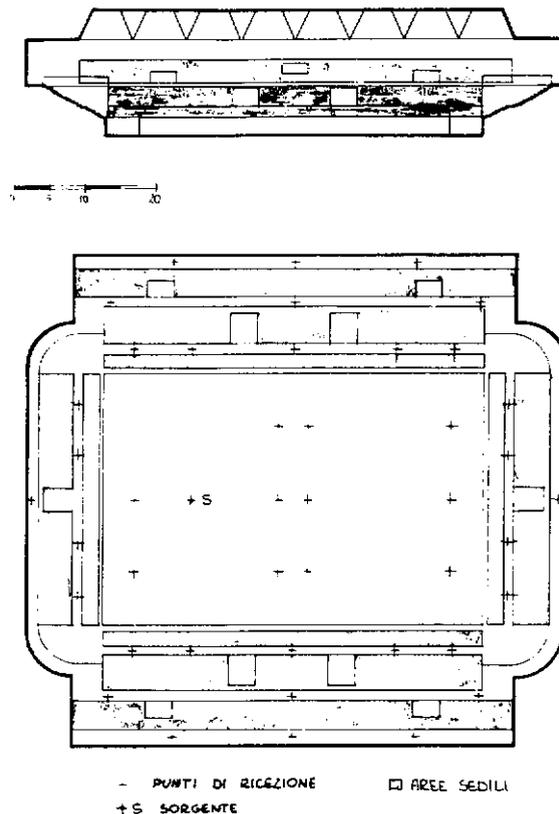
SEZIONE LONGITUDINALE E PIANTA DEL PALAZZETTO DELLO SPORT
